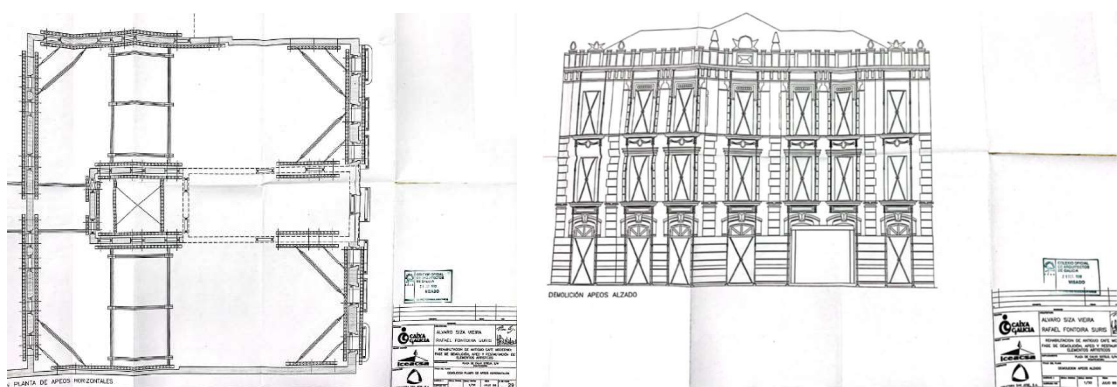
Planta de apeos horizontales / Apeos alzado principal.
